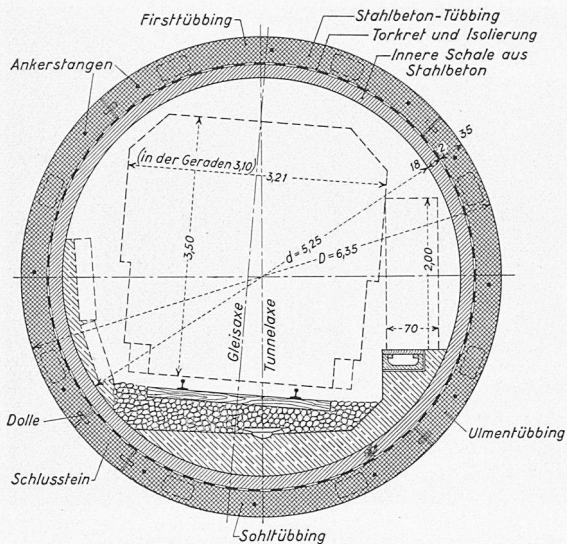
Eingleisige Tunnelröhre aus Stahlbetonfertigteilen, Schnitt 1:100
